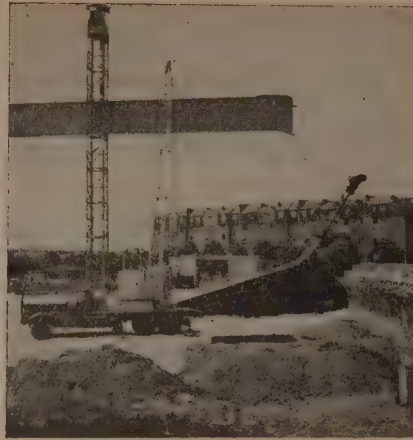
Poutre du portique de 60 m levée. Béquille prête au levage.
